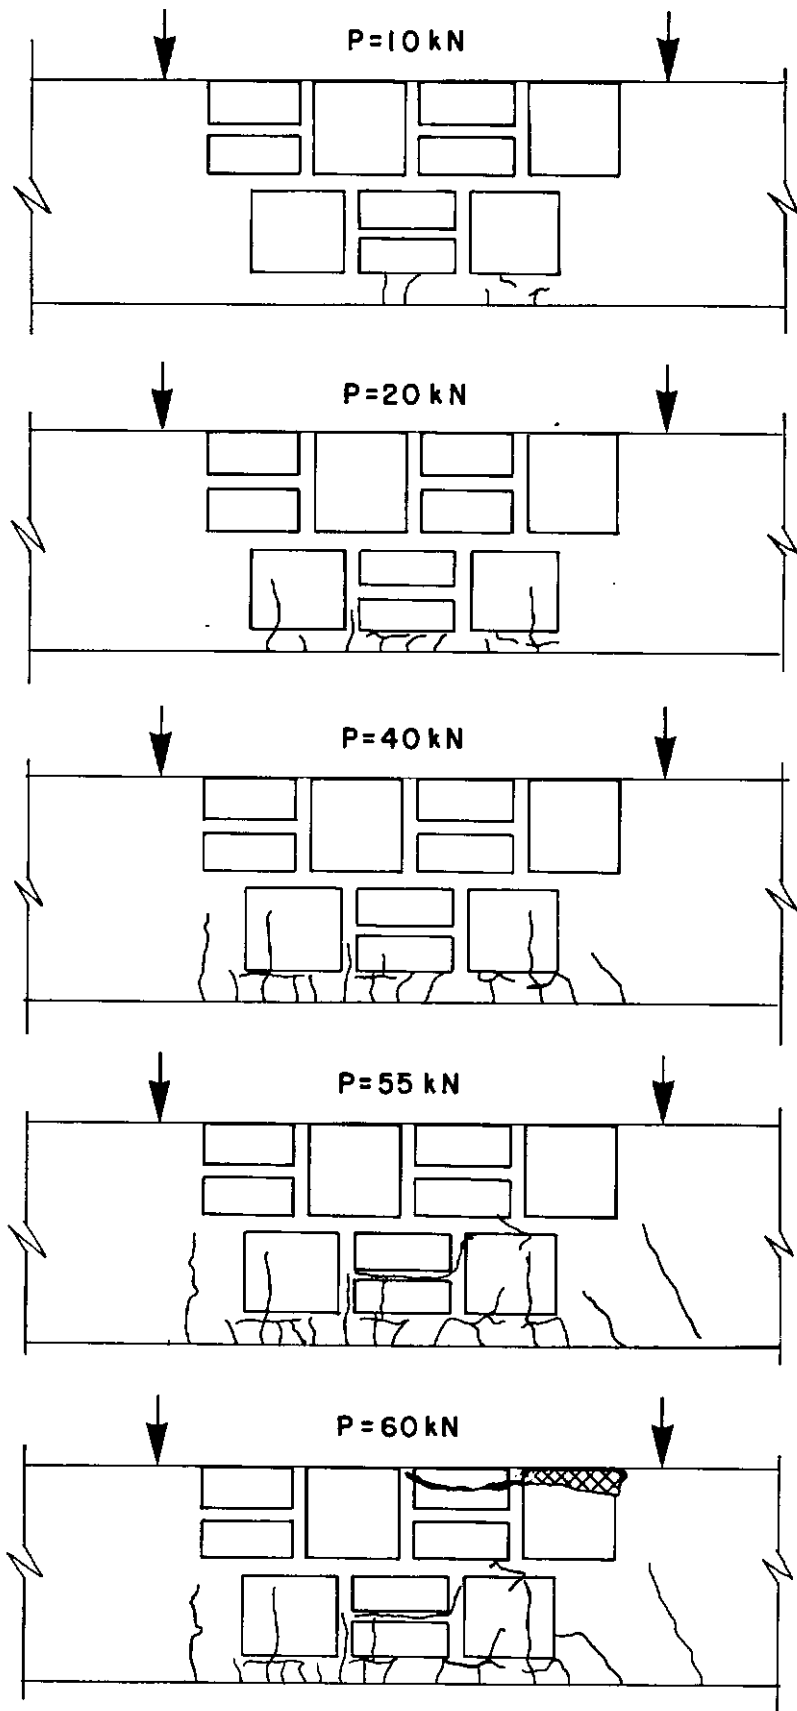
FISSURAÇÃO DA VIGA V2C
